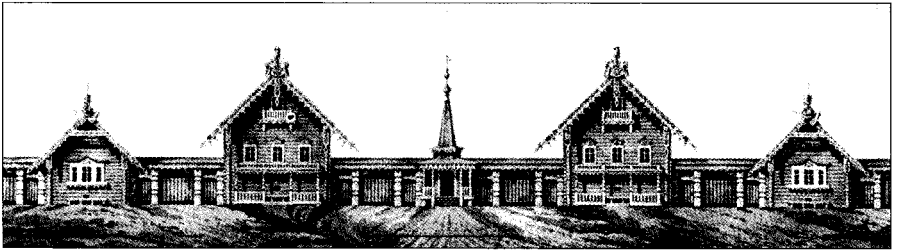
Glasowo. Fassadenansicht Variante 2, Carlo Rossi 1815.
